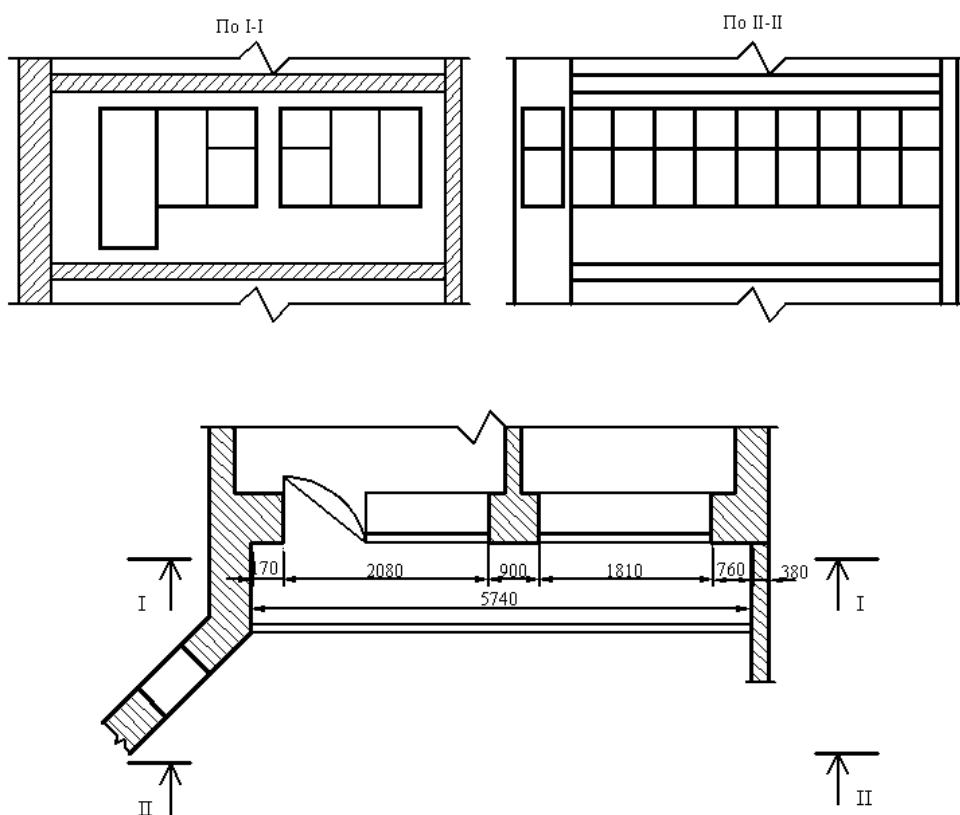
Разрезы по сечениям I-I и II-II плана и план остекленного балкона многоэтажного жилого здания
